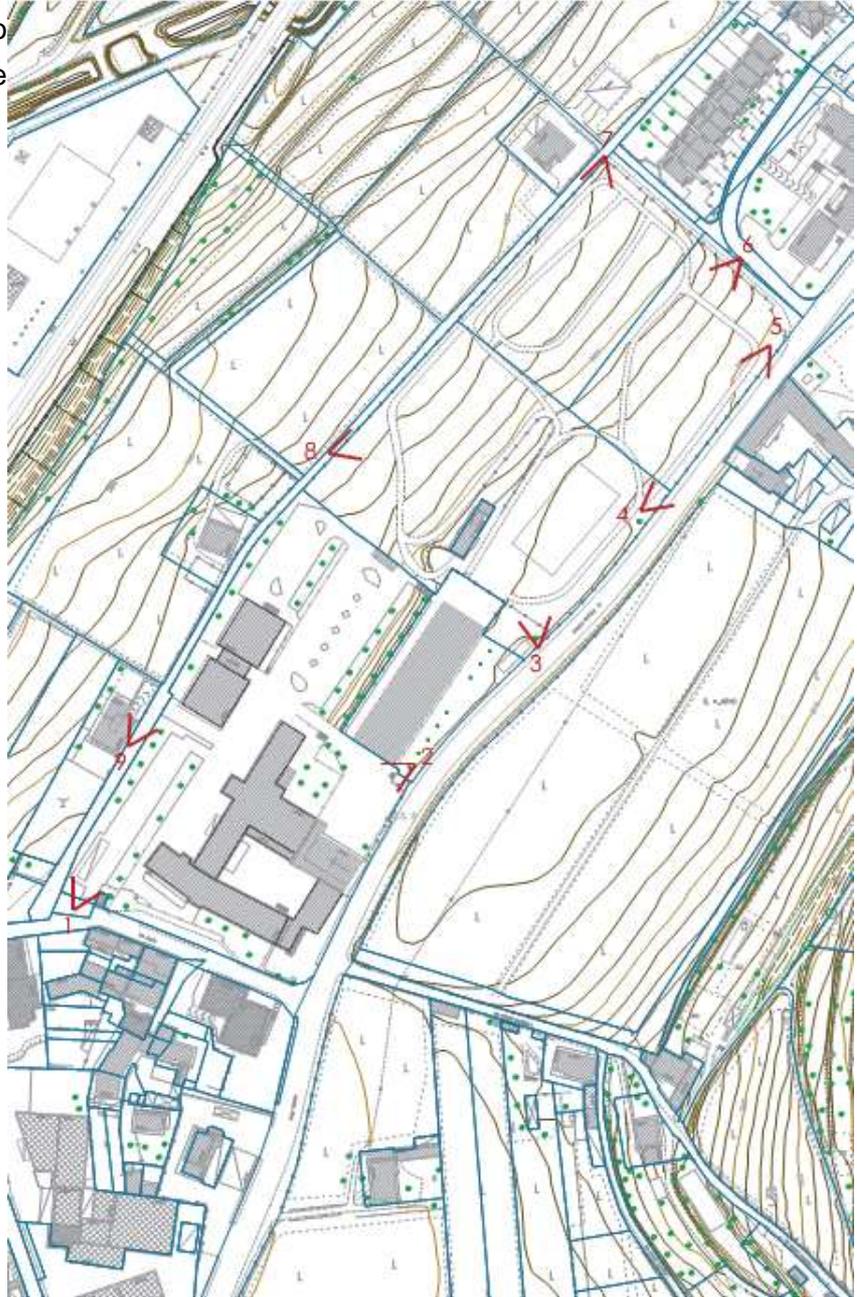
Illustrazione 13: Planimetria con punti di ripresa - estratto Mataprogetto S. Ilario
